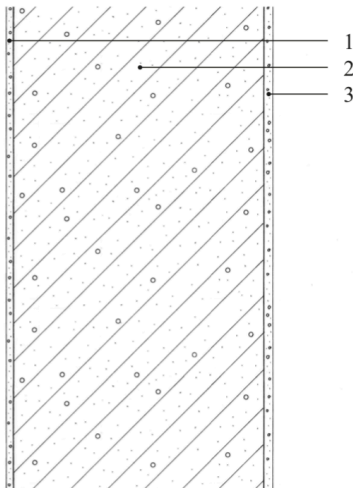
Wandaufbau Einsteinmauerwerk (Swissbrick, 2012, S. 39)
